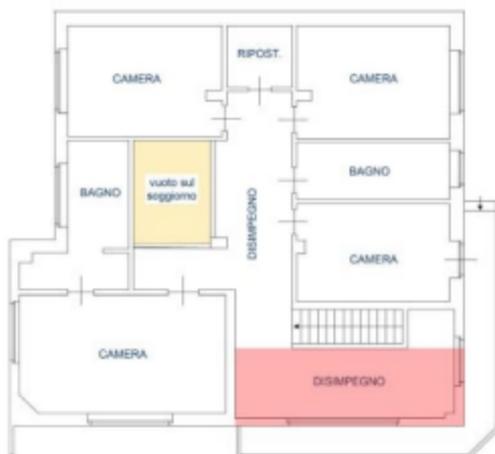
planimetria PIANO PRIMO di rilievo dello stato di fatto
